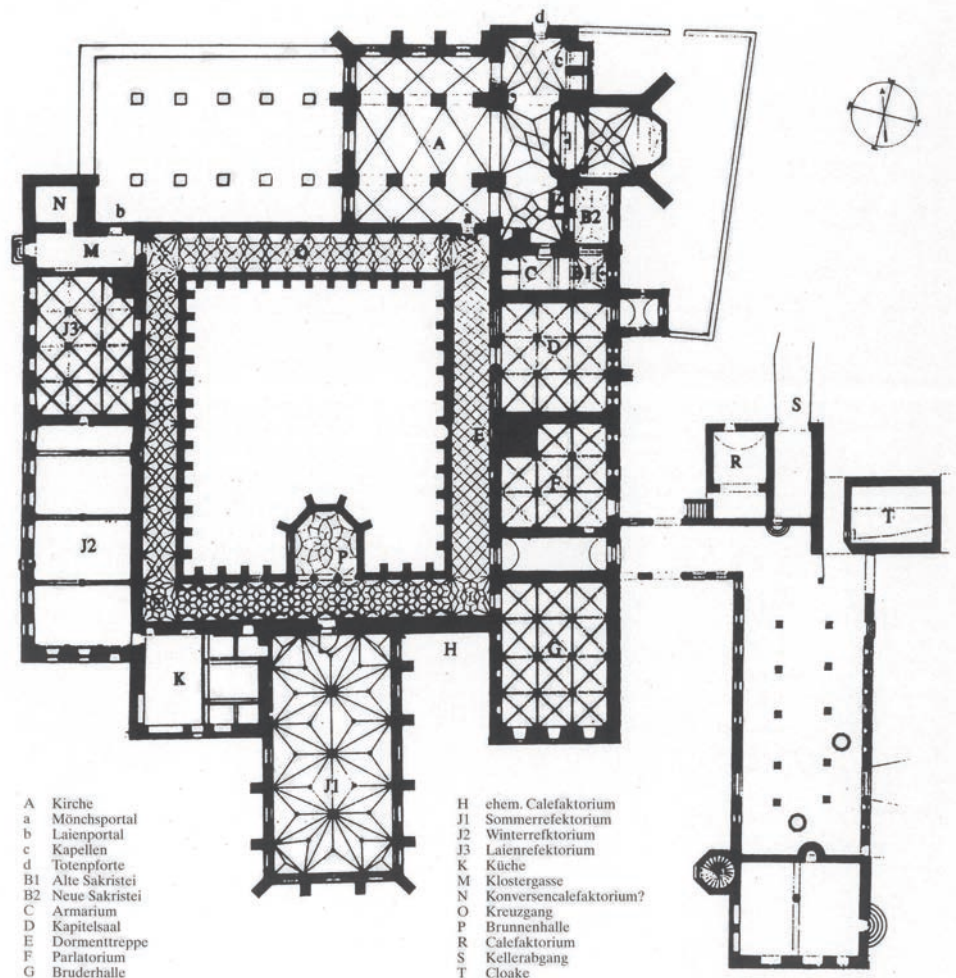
Grundriss der Klosterbauten von Bebenhausen (Leibniz 1858).
